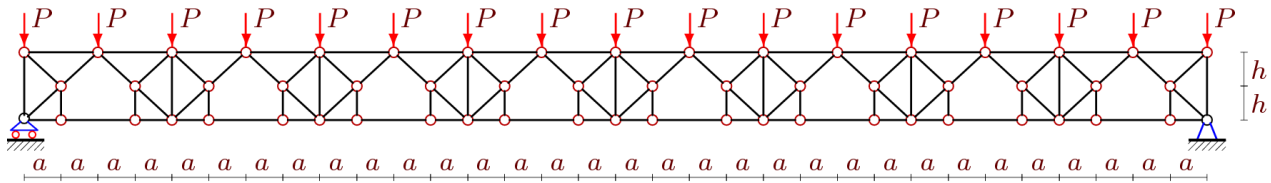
Нагрузка на узлы верхнего пояса, $n = 4$
